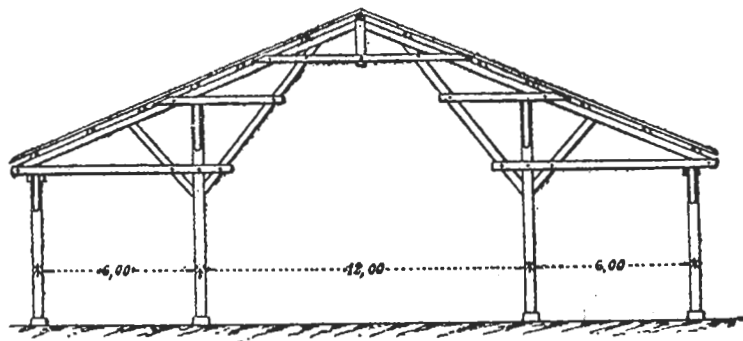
ARMADURAS SOBRE PIES DERECHOS
